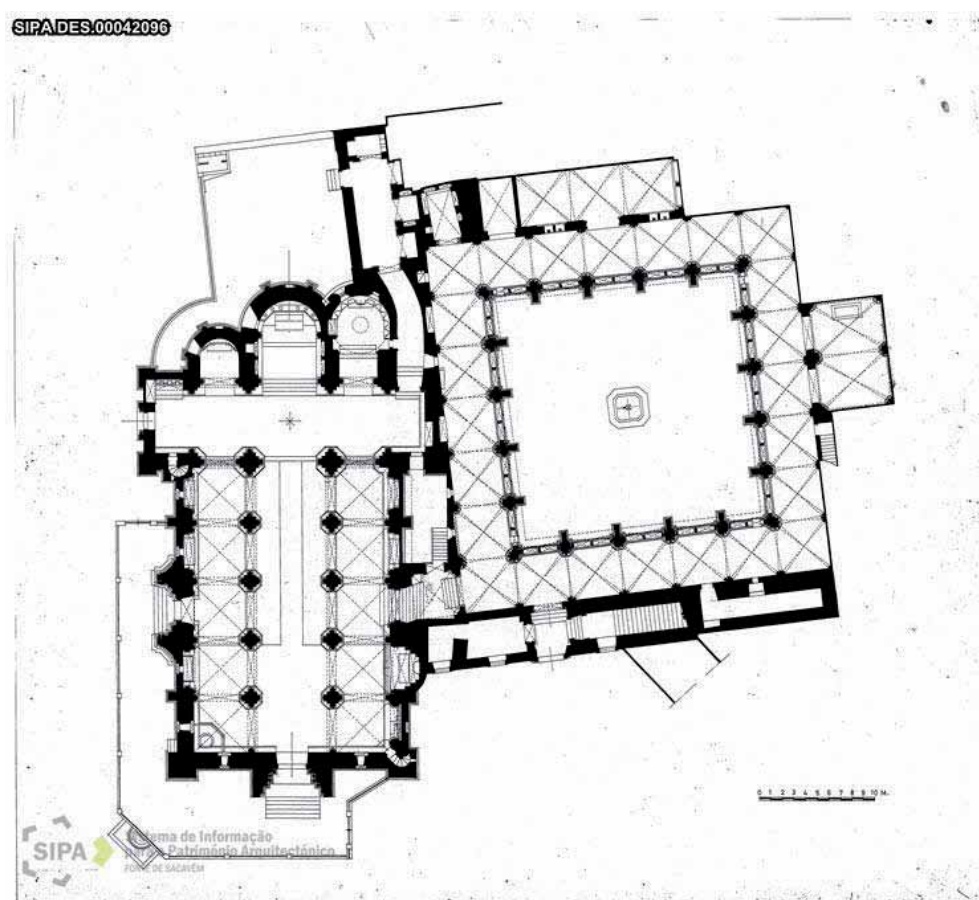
Planta de la catedral de Coímbra antes de las obras de restauro. IHRU
